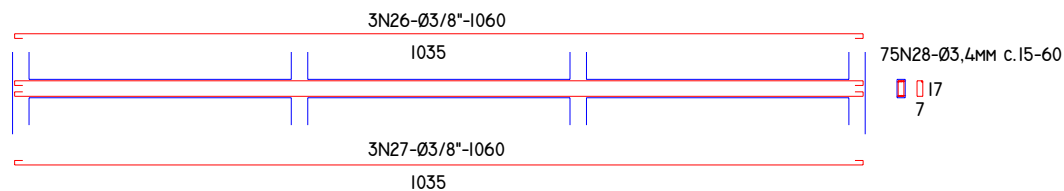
Planta de armação das vigas à nível de cobertura da creche (suinocultura).
